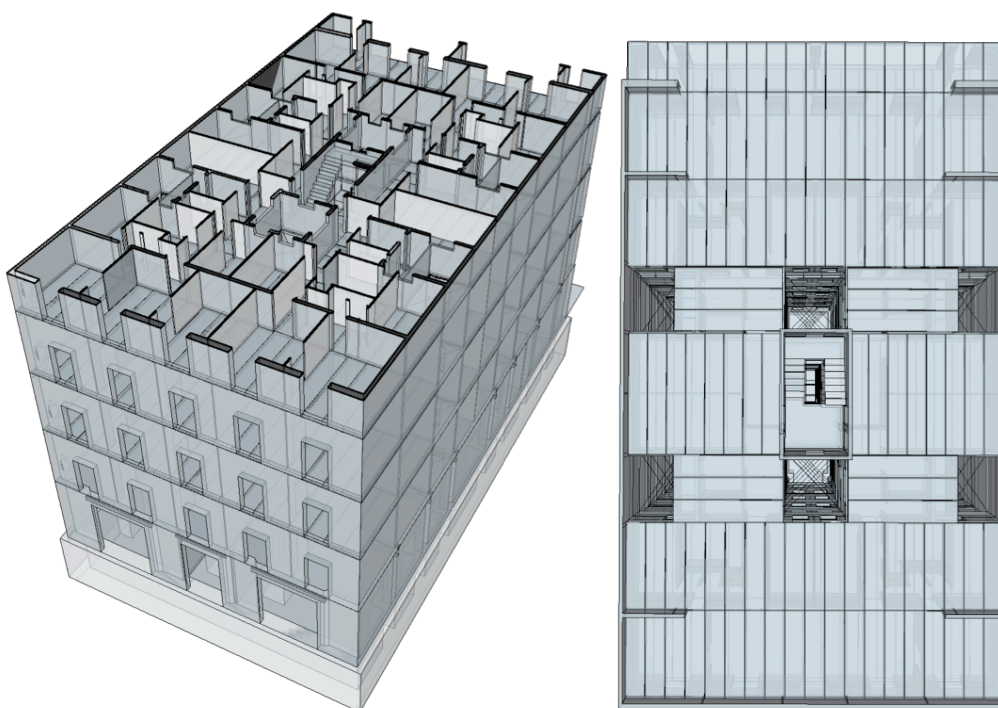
Distribución en planta tipo del edificio ED-01. Izquierda: isométrico. Derecha: vista en planta y dirección de forjados (fuente: elaborado por el autor)
